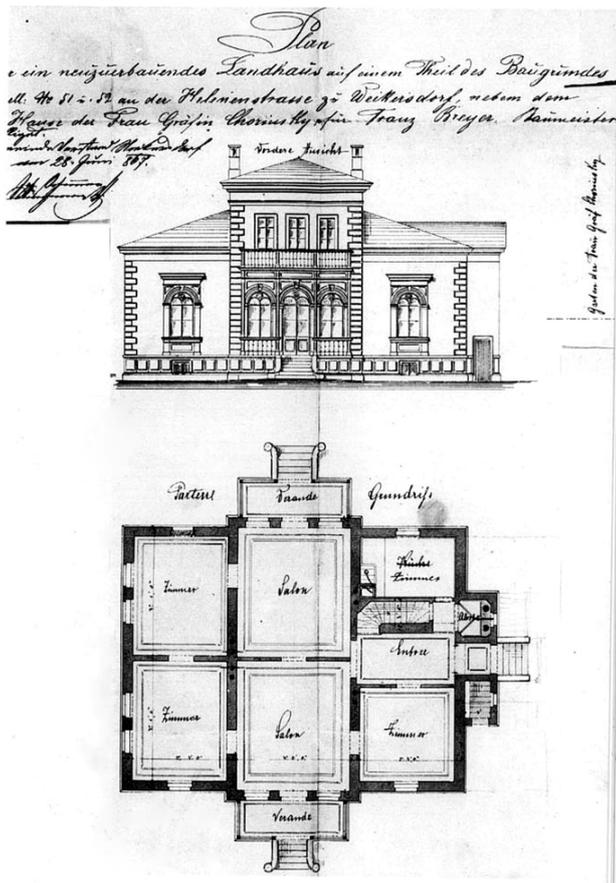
Villa Helenenstraße 6 in Baden. Auf- und Grundriss. 1867. Einreichplan.
